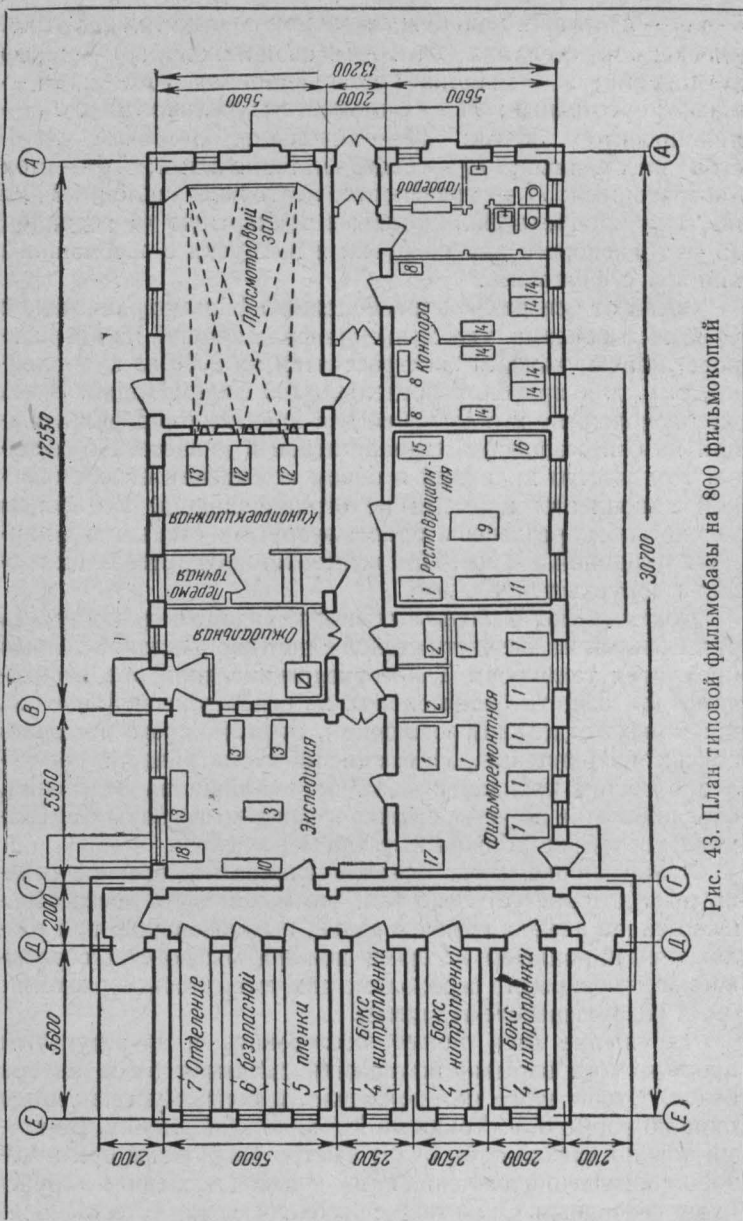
План типовой фильмобазы на 800 фильмокопий
